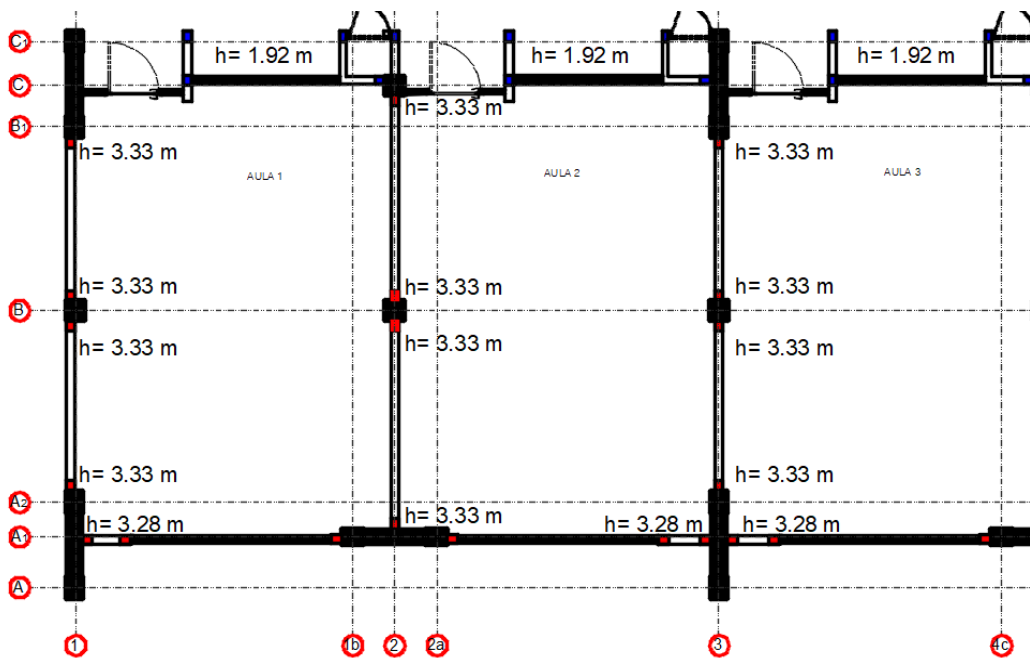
Zoom columnetas AUTOCAD – fuente propia
